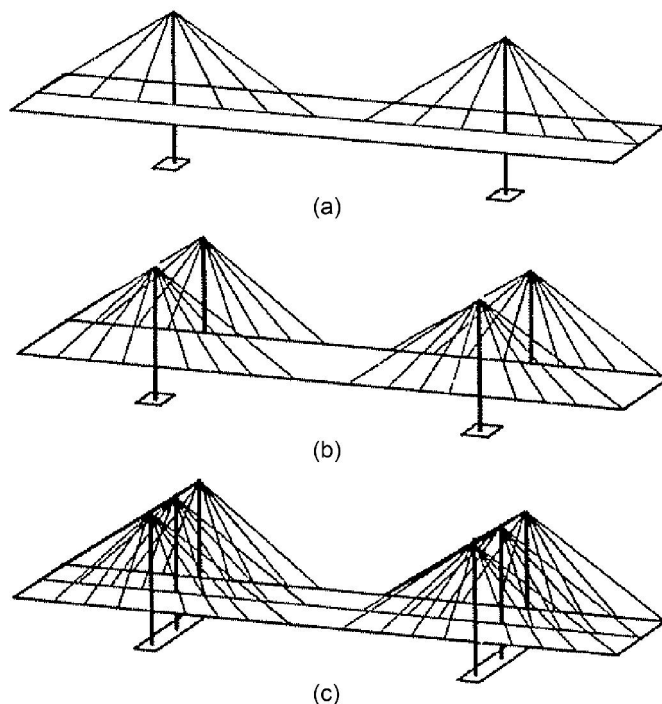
Configurações transversais: (a) um plano de suspensão, (b) dois planos de suspensão (suspensão lateral), e (c) três planos de suspensão (Walther, R. [et al.], 1999).
